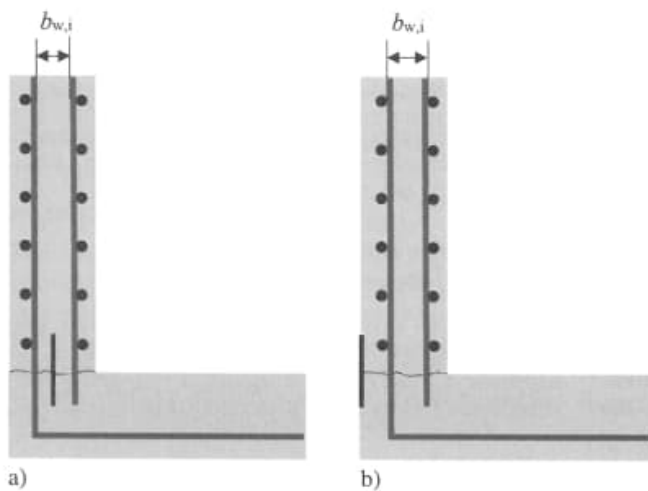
Beispiele für lichte Innenmaße $b_{w,i}$ bei Ortbetonwänden; a) lichter Abstand zwischen 2. Lage Bewehrung wegen Betonierbarkeit bei innenliegender Fugenabdichtung, b) lichter Abstand zwischen horizontaler Bewehrung wegen Betonierbarkeit mit Betonierschlauch und Verdichtung mit Rüttelflasche bei außenliegender Fugenabdichtung
